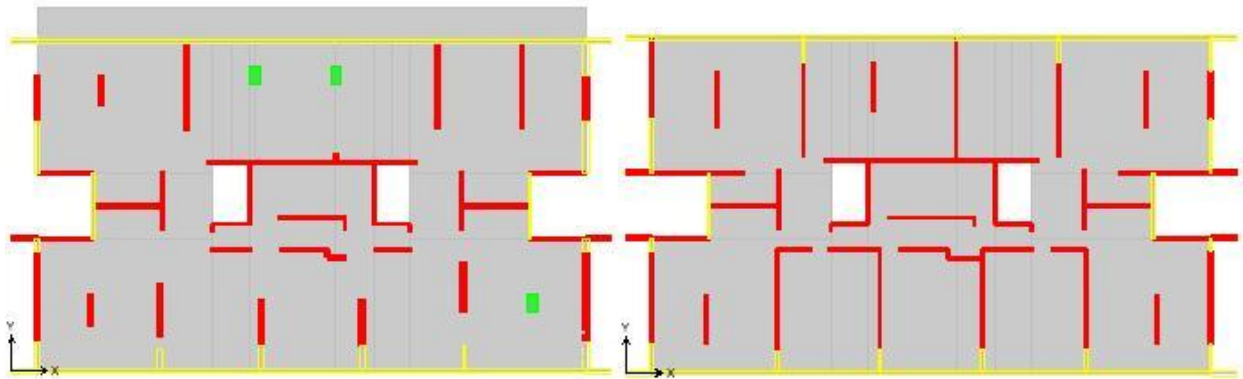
Planta primer piso (izquierda) y piso tipo (derecha) edificio H9
